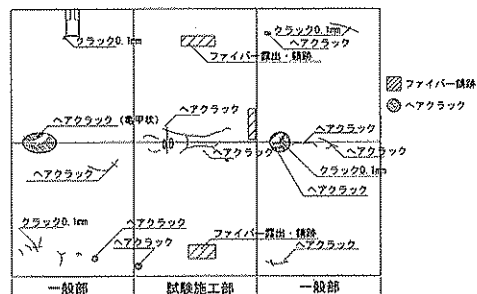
Aトンネルの覆工でのひび割れの発生状況
